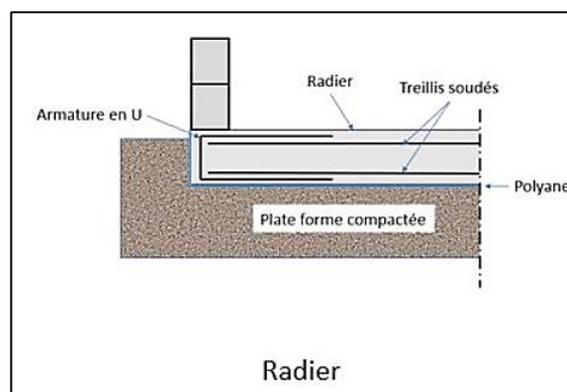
Fondation radier source : [beton/https://www.toutsurlebeton.fr/mise-en-oeuvre/le-radier-de-fondation-en-beton/](https://www.toutsurlebeton.fr/mise-en-oeuvre/le-radier-de-fondation-en-beton/)
